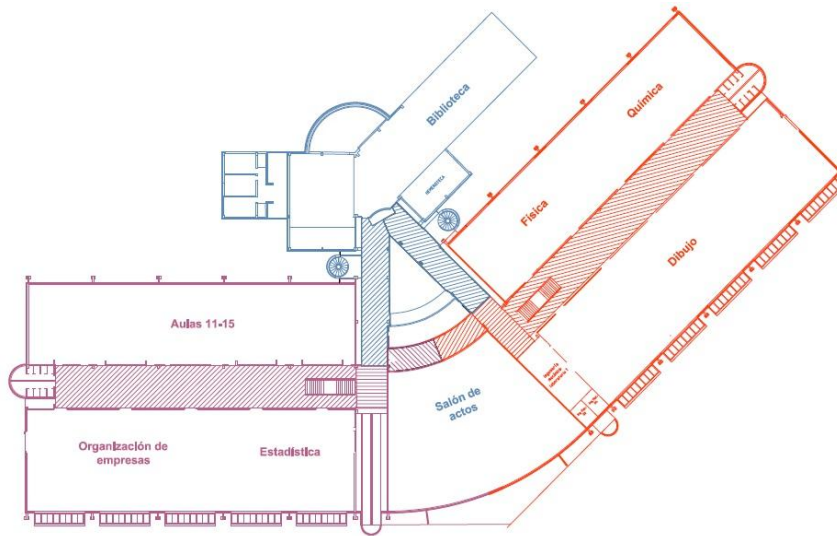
Distribución de zonas de iluminación. Edificio central planta alta
